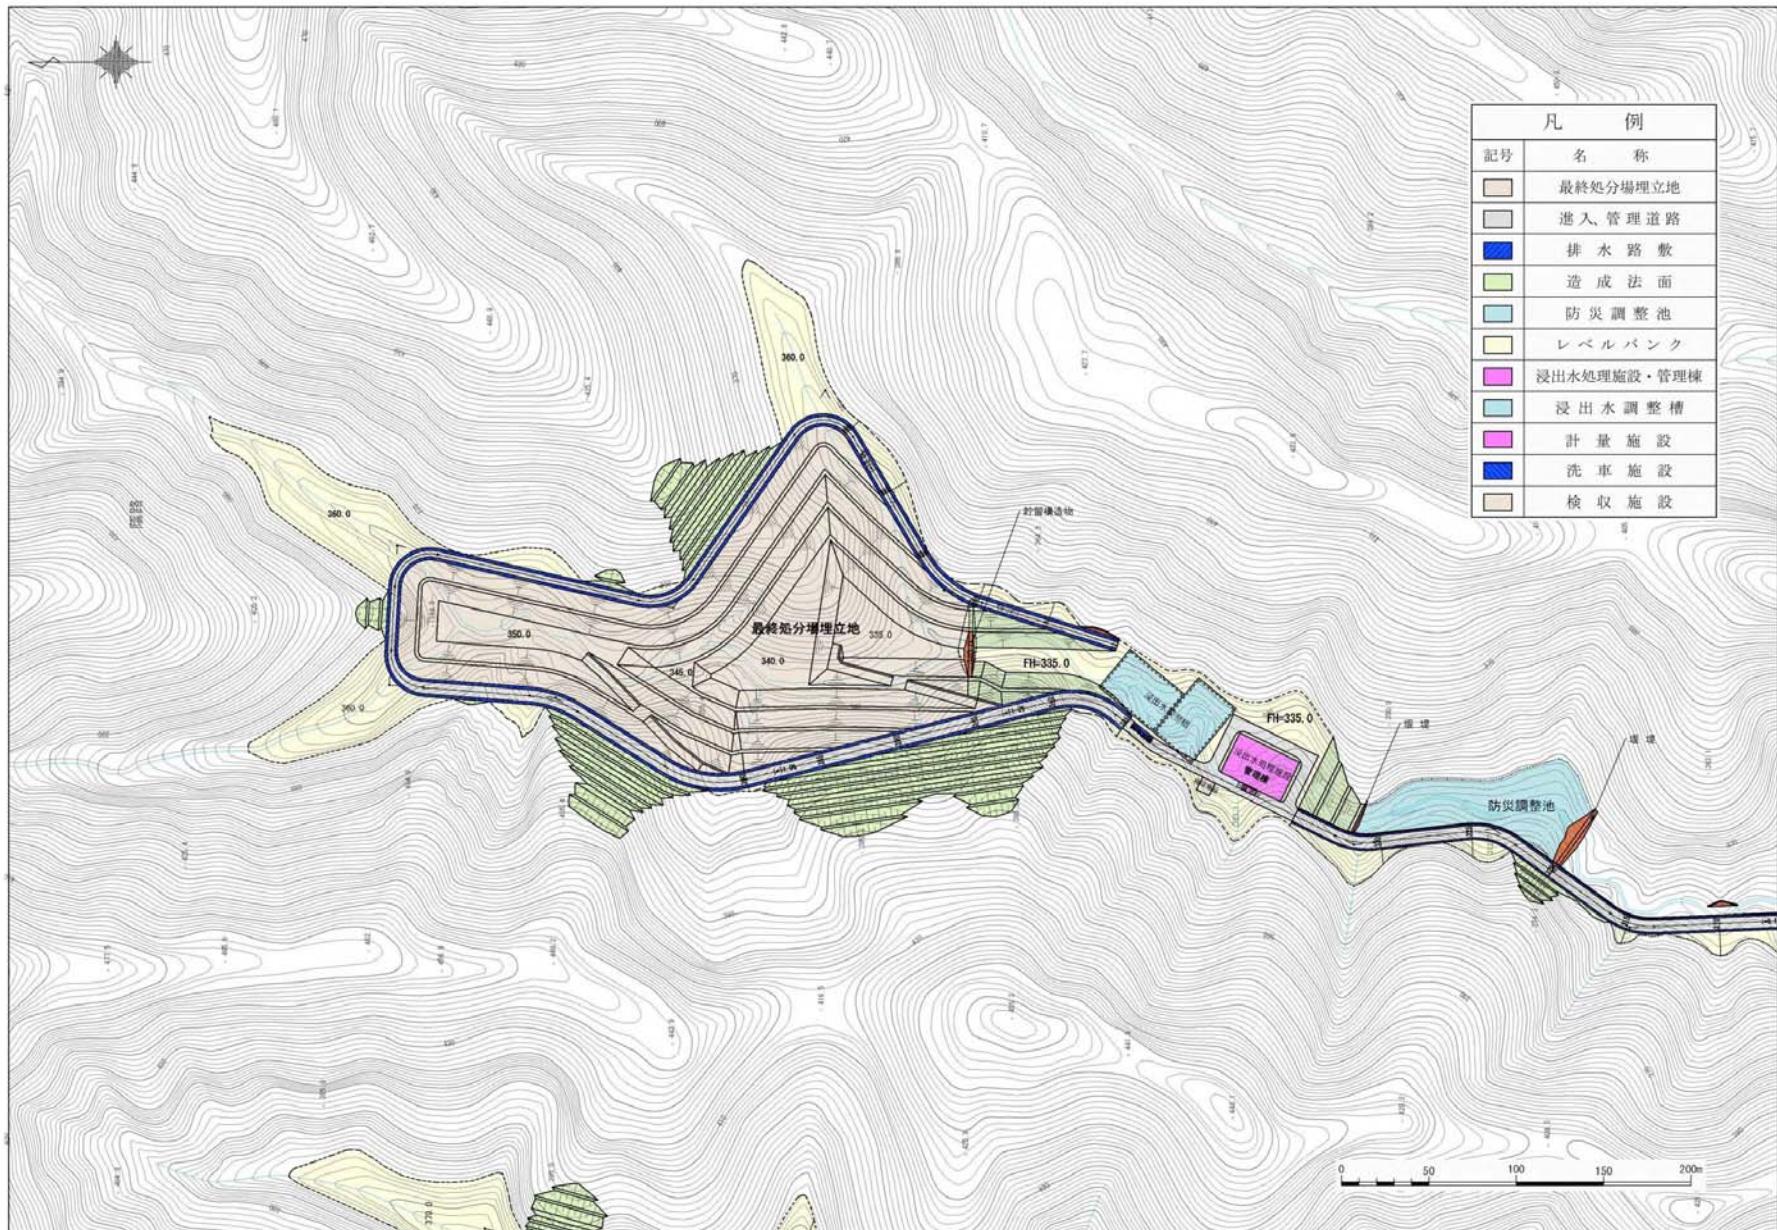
秋津川東〔No.2 2-3〕全体配置計画図
